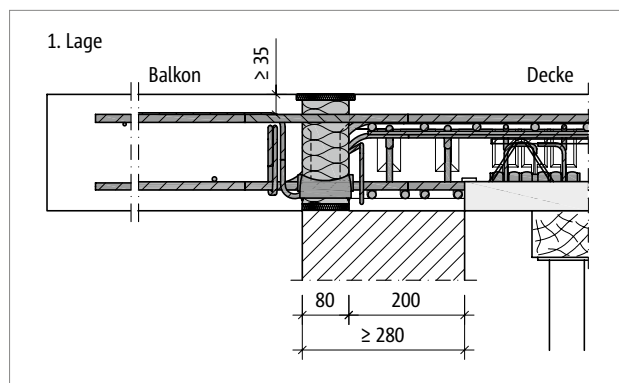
Schöck Isokorb® T Typ C: Halbfertigteilplatte mit Randunterstützung mit wärmedämmendem Mauerwerk (Schnitt T Typ C-CV35-1. Lage, Ansicht T Typ C-CV50-2. Lage)
